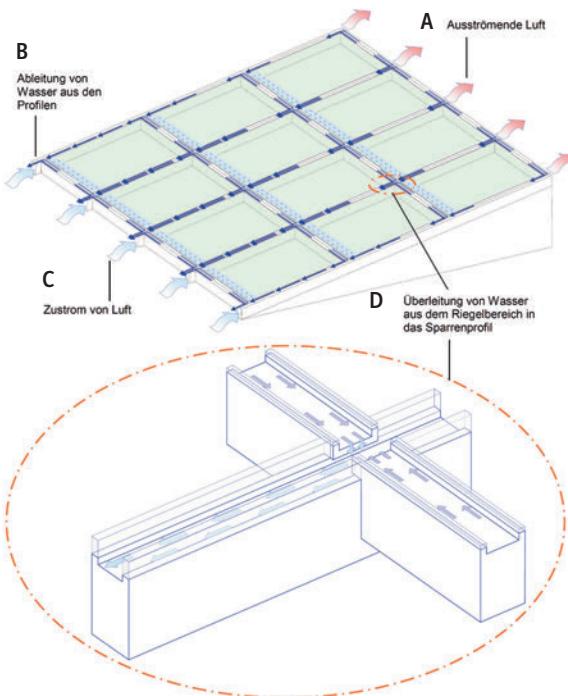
Belüftung und Wasserführung in der Konstruktion gering geneigter Dachverglasungen.
